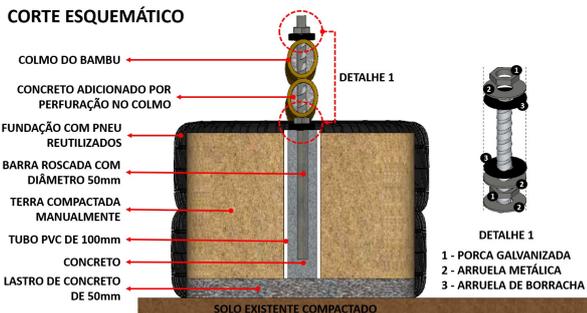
Corte esquemático da fundação. Fonte: elaborada pelos autores.
